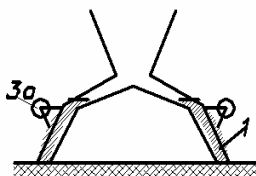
Бетонирование в перевернутом виде: 1-двусторонняя опалубка; 2-вибратор
